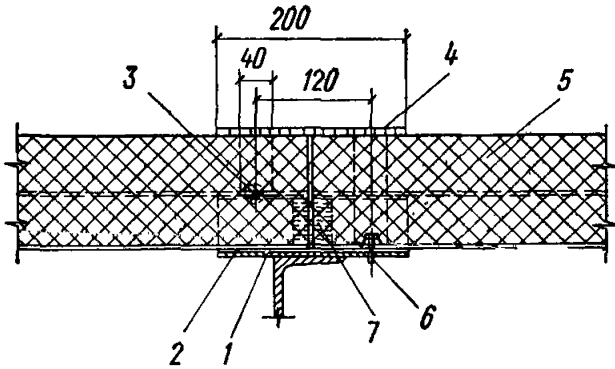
Поперечный стык между панелями с применением подкладки по форме настила
